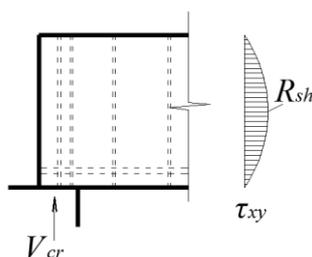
Модель к расчету усилия образования наклонных трещин II типа в зоне среза изгибаемого железобетонного элемента [3]
